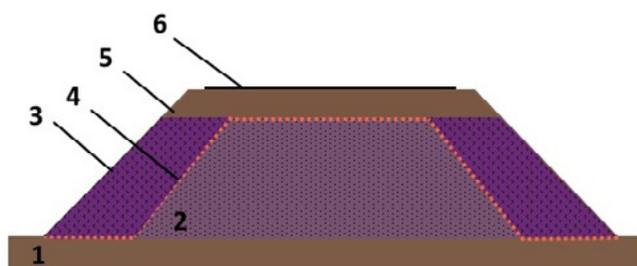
Вертикально слоистая конструкция насыпи на мерзлом основании: 1 – мерзлое основание; 2 – внутренняя полоса; 3 – крайние полосы; 4 – геополотница; 5 – слой дренирующего грунта; 6 – цементно-бетонное полотно.
